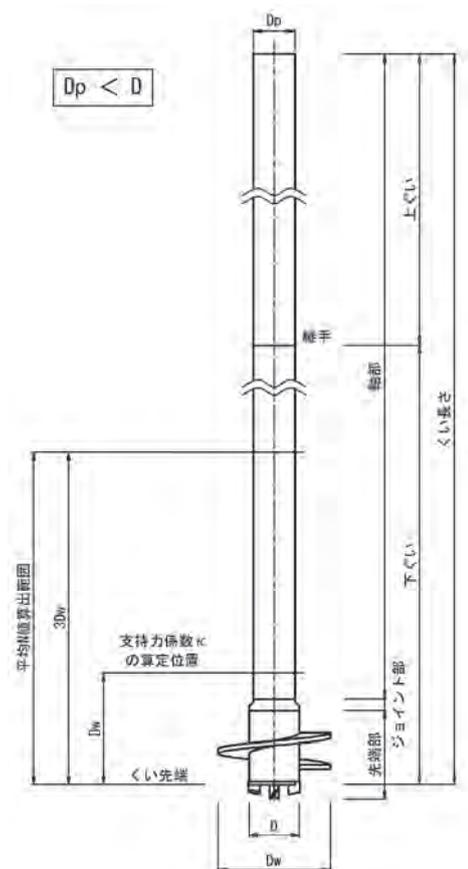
基礎ぐいの構造 (TGジョイント有の場合)
